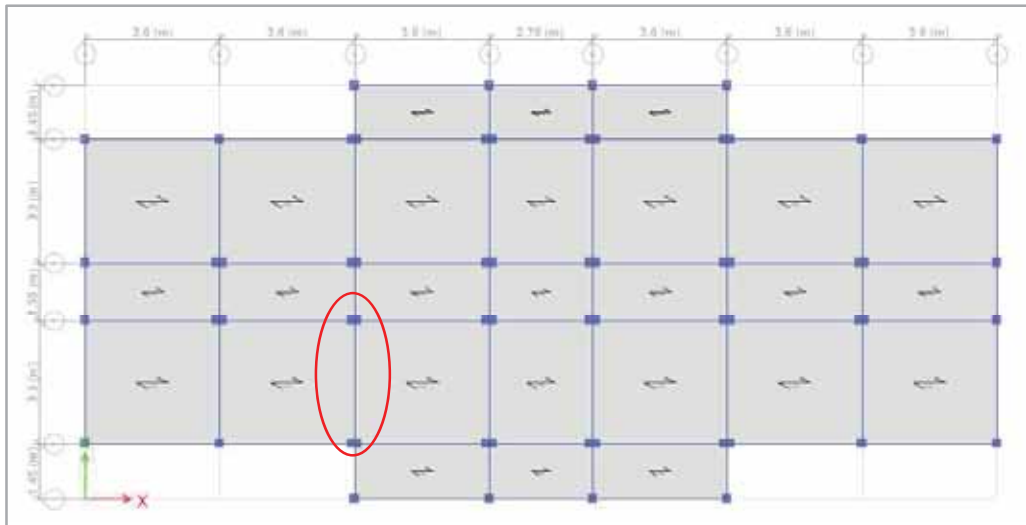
Vista en planta del pórtico donde se determinó la distribución de los refuerzos de acero, eje C2-C3. (Elaboración propia)
